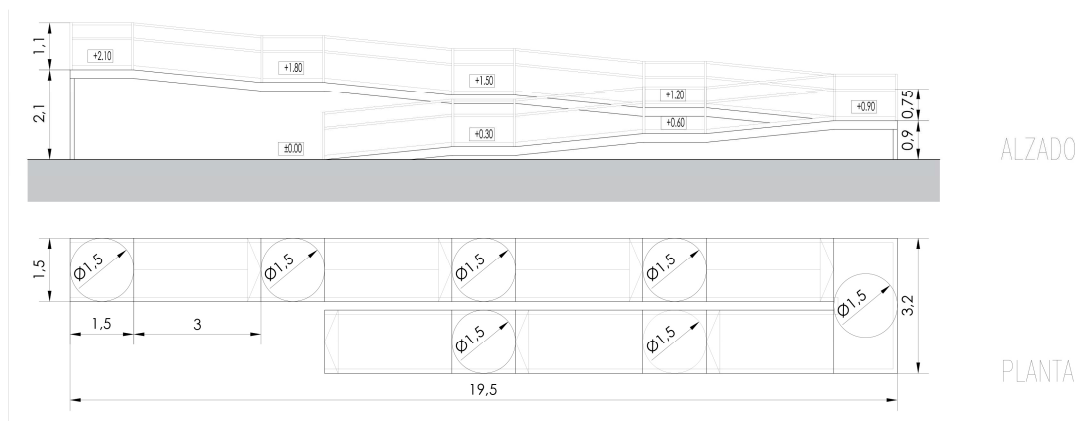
Rampa proyectada. Fuente: Elaboración propia.
